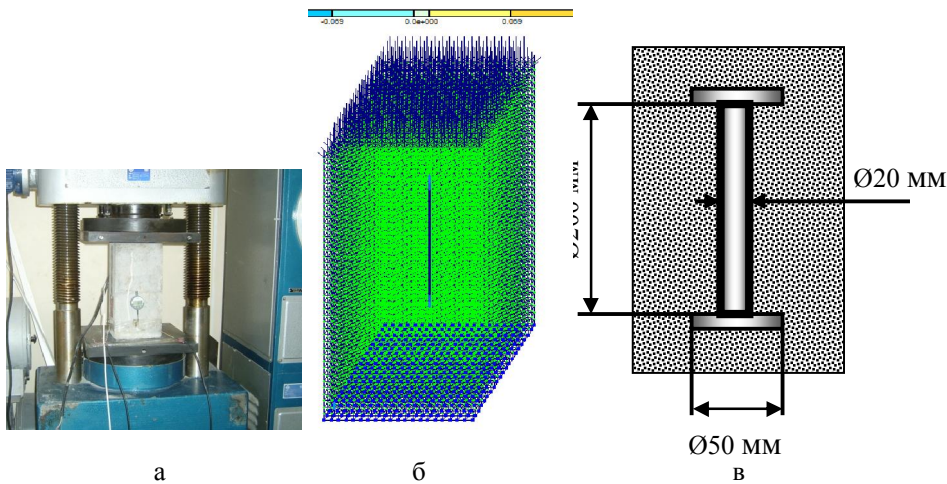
Натурные испытания и конечно-элементная модель фрагмента железобетонной колонны с замоноличенным тензосметром: а – фрагмент колонны с тензосметром; б – конечно-элементная модель тензосметра в бетоне; в – схема заделки тензосметра в бетон
